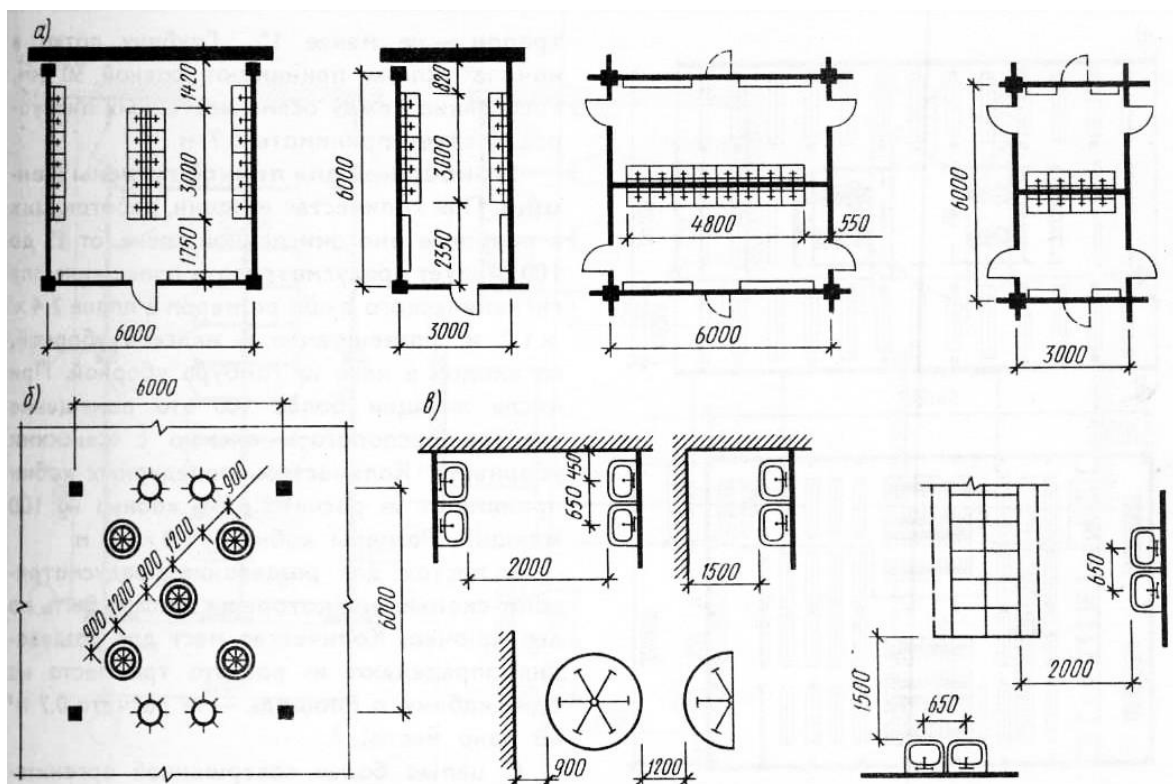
Примеры планировочных решений помещений умывальных и их оборудования:
